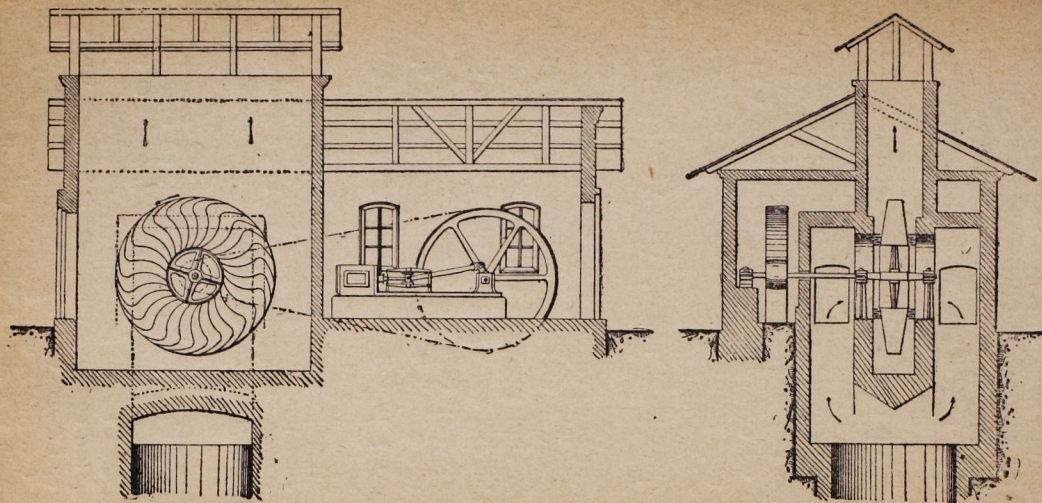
Ventilateur aspirant Farcot, mû par machines à vapeur (pour usines)
